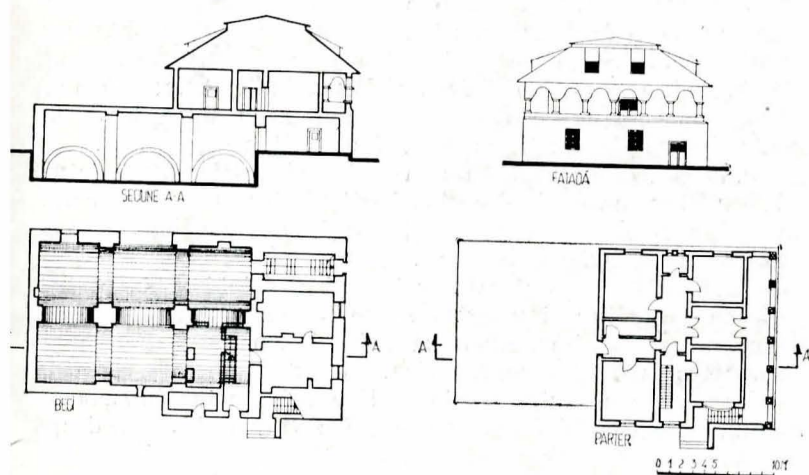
Conacul Brîncoveanu-Mavrocordat de la Tătărani — plan beci, plan etaj, secțiune și fațadă.
